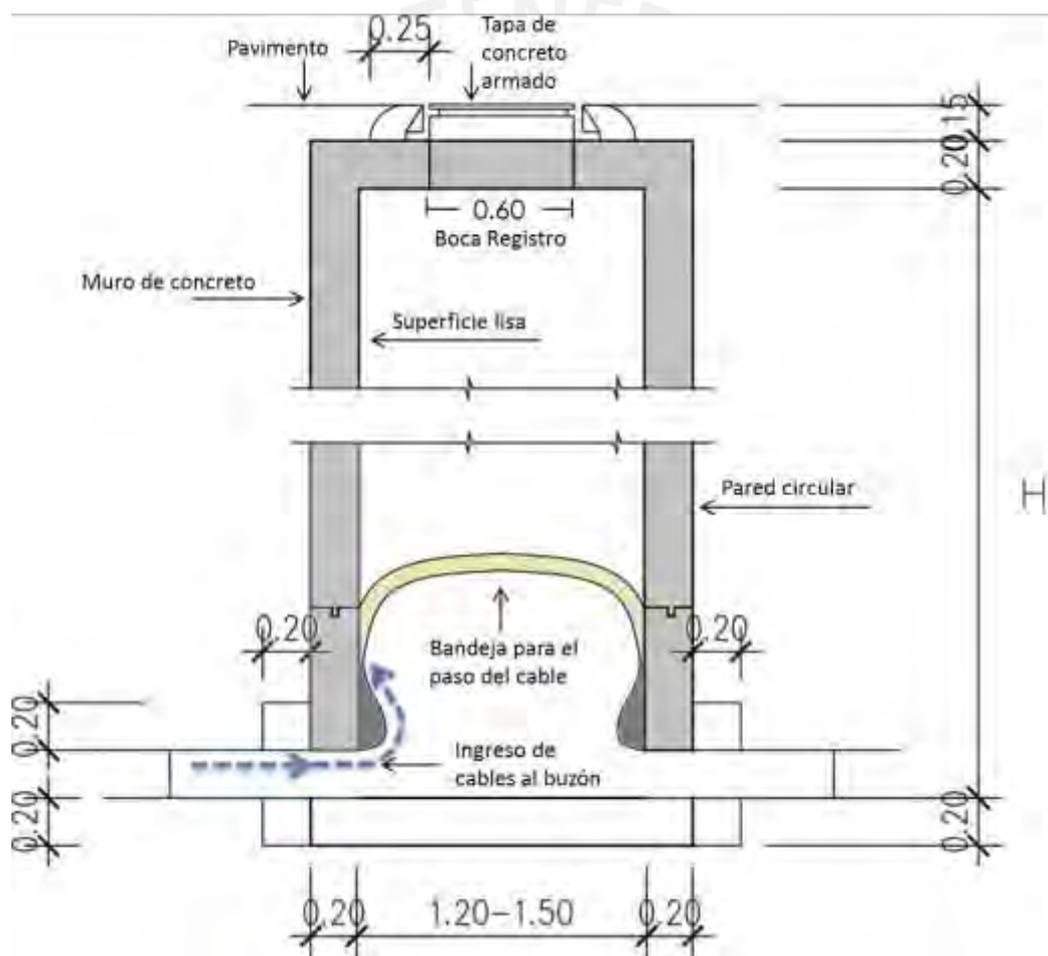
21: Vista transversal de buzón de alcantarillado. Medidas en metros [Elaboración propia] [38]
